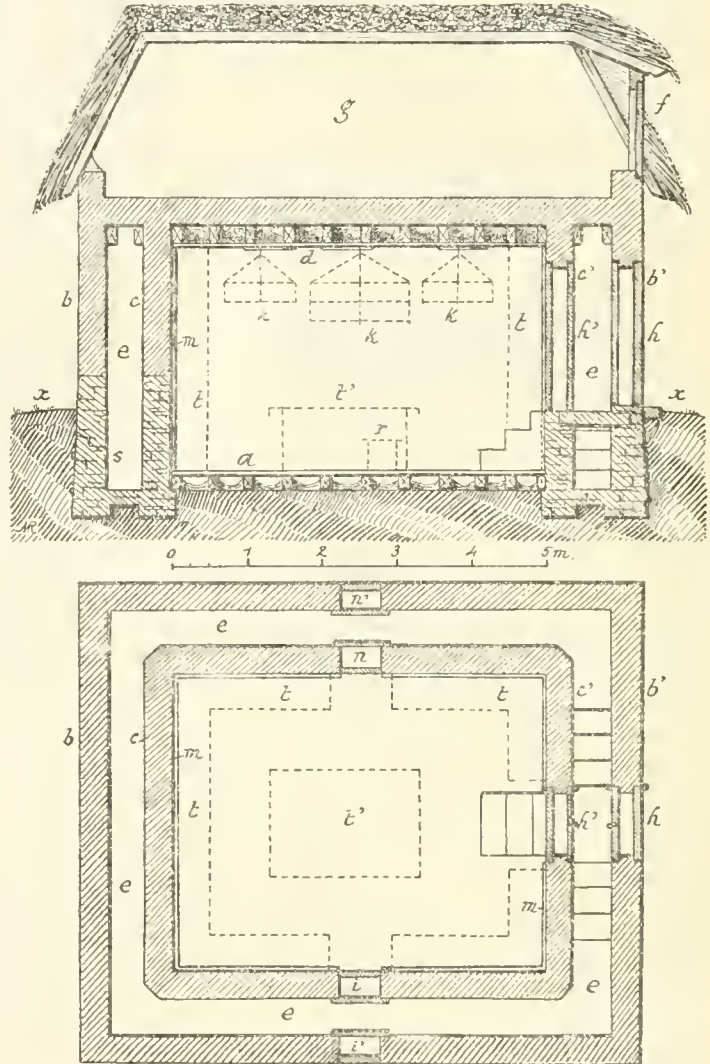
Coupe en élévation et plan d'un fruitier.
